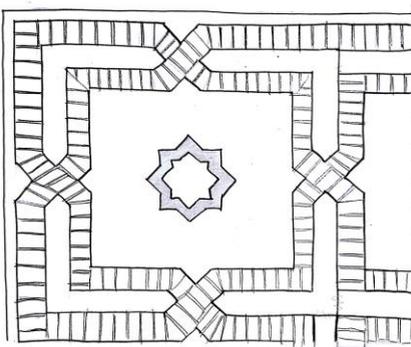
Detalle del aparejo de las estrellas mudéjares, 2015. Pablo Torres
